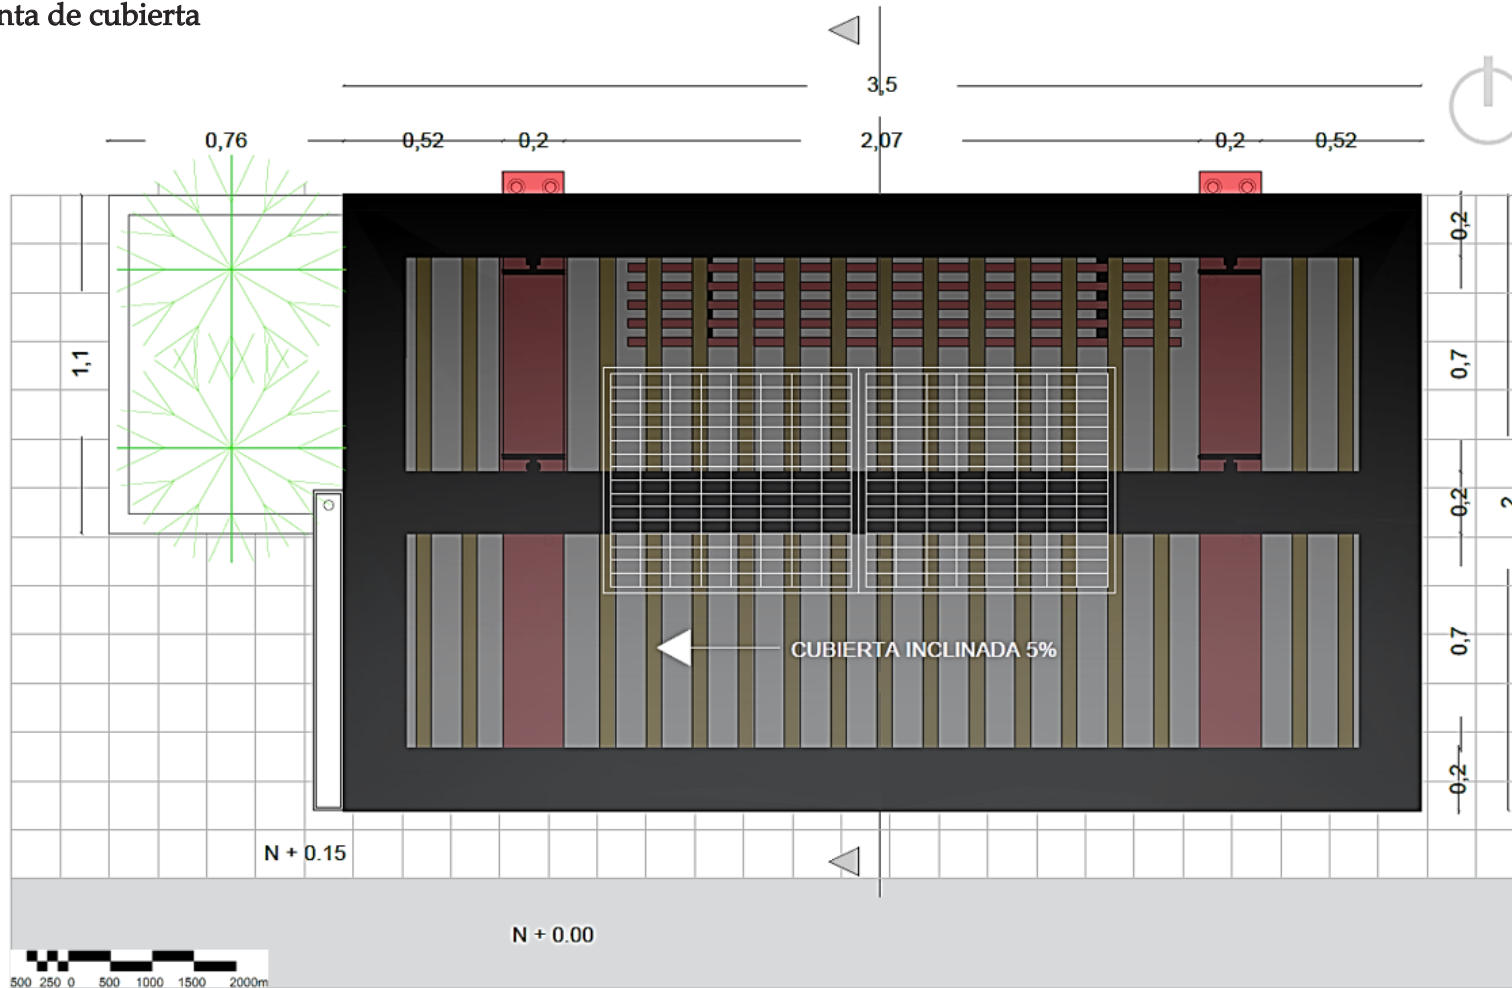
Planta de cubierta del mobiliario de las paradas menos utilizadas, escala 1:25. Elaboración propia.
